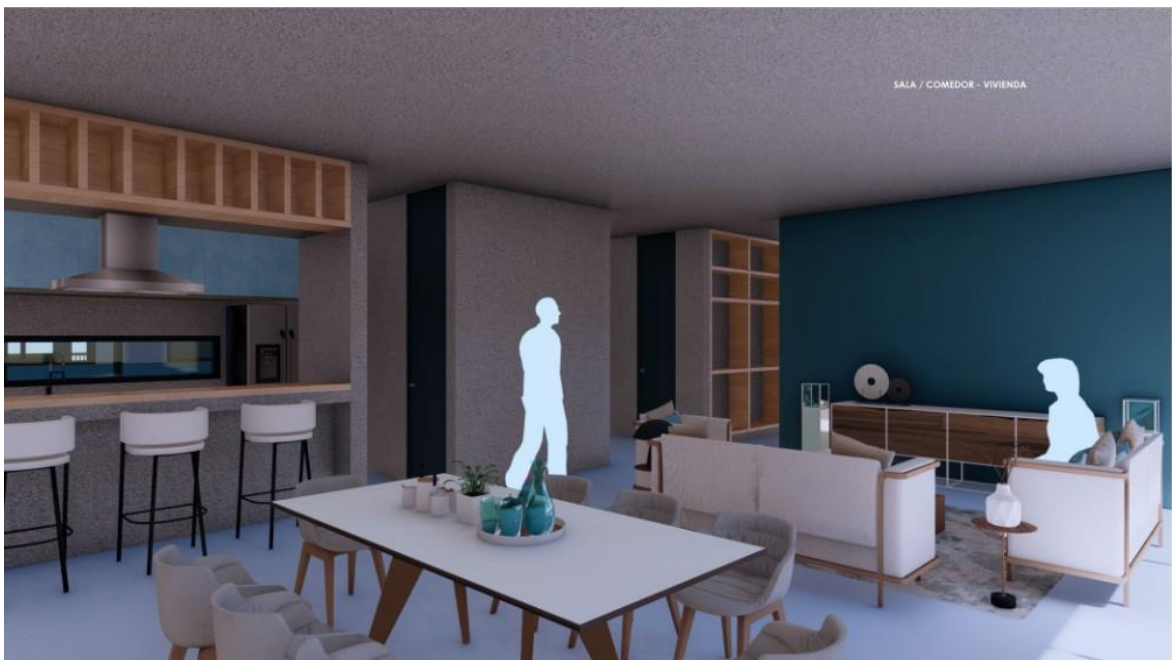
Vista Arquitectónica desde Interior de Vivienda
